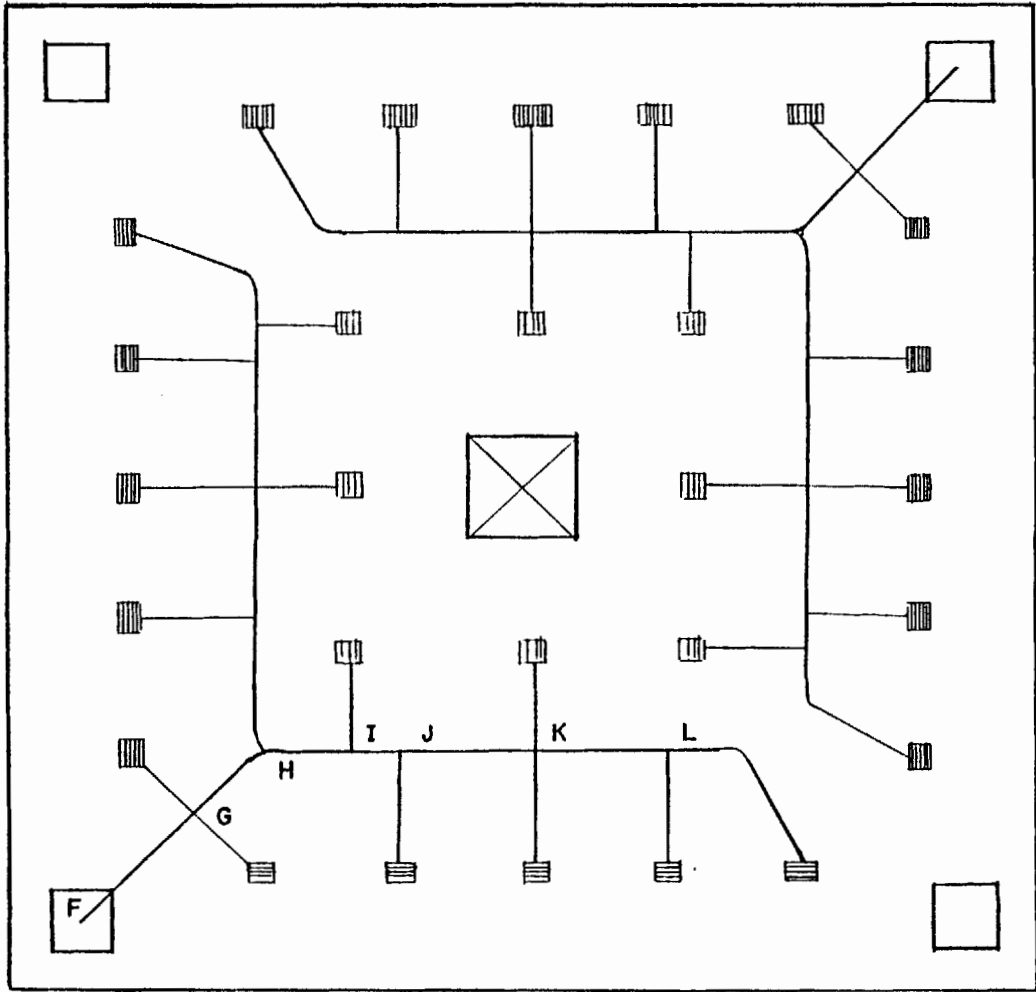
ESQUEMA DEL SISTEMA DE DUCTOS DE SUMINISTRO ( EN PLANTA )
